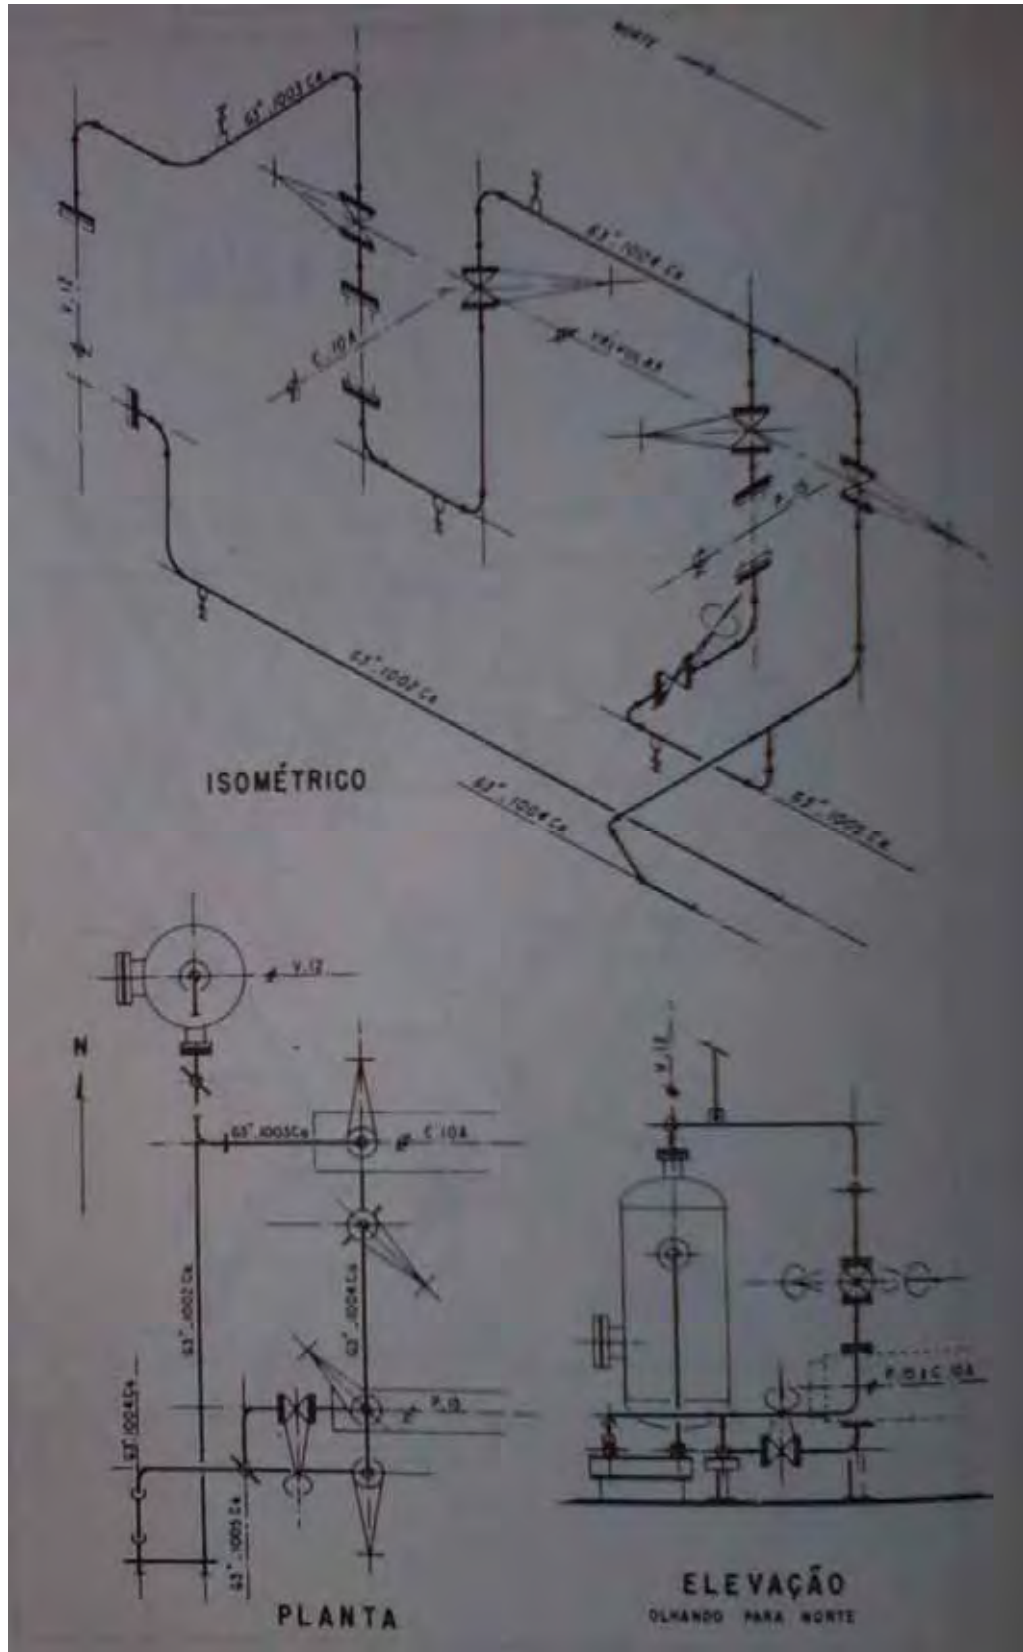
Tubulação sob a perspectiva isométrica e no desenho técnico tradicional em duas dimensões. Fonte: Silva Telles (1994).
